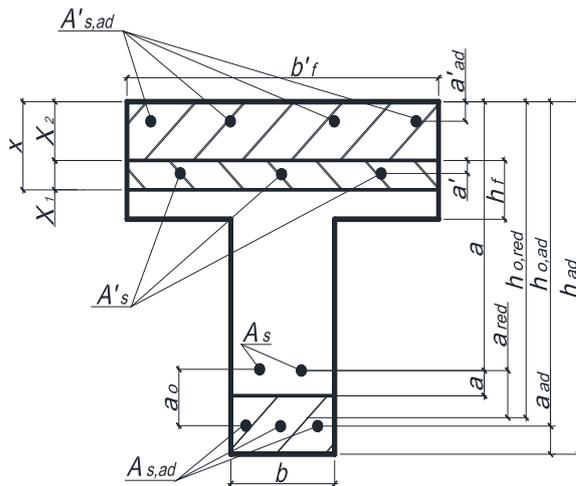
Расчетная схема усиления элемента таврового профиля по первому случаю ($x \leq h'_f$)
